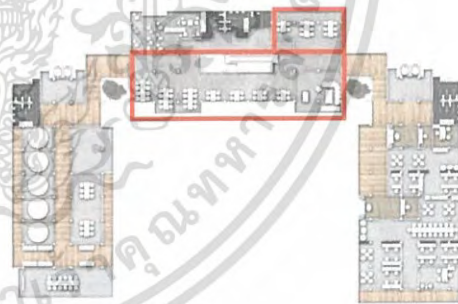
WORK SPACE & PLAY ZONE
